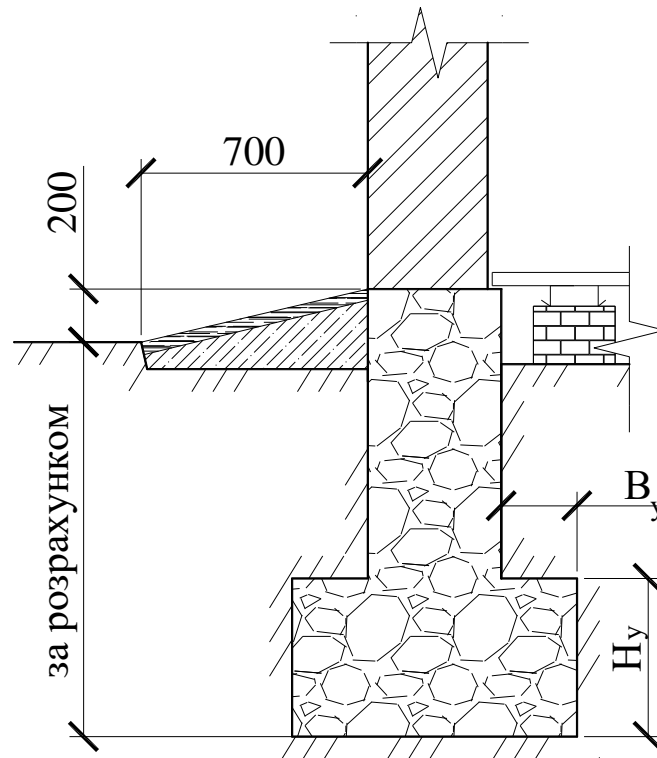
Стрічковий бутовий фундамент з уступами
